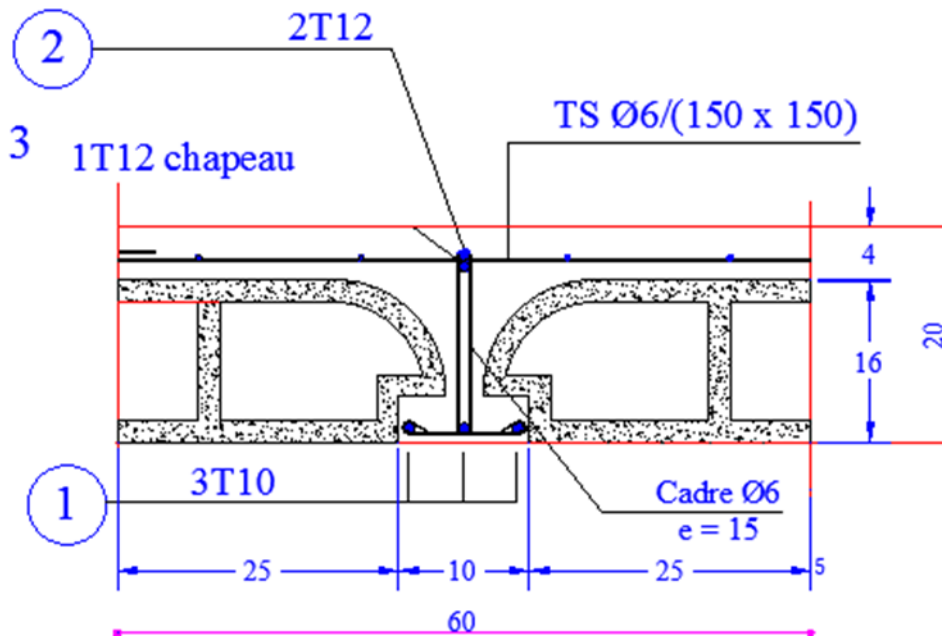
ferrailage de poutrelle Plancher terrasse
